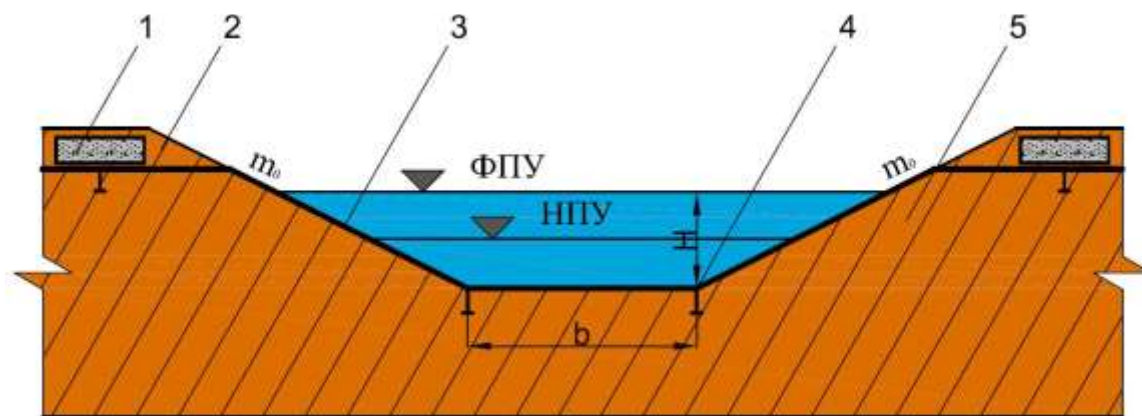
Схема поперечного сечения резервного водосброса [29]: 1 – железобетонная плита; 2 – бровка водосливной части; 3 – геомембрана; 4 – анкер; 5 – грунтовая плотина
